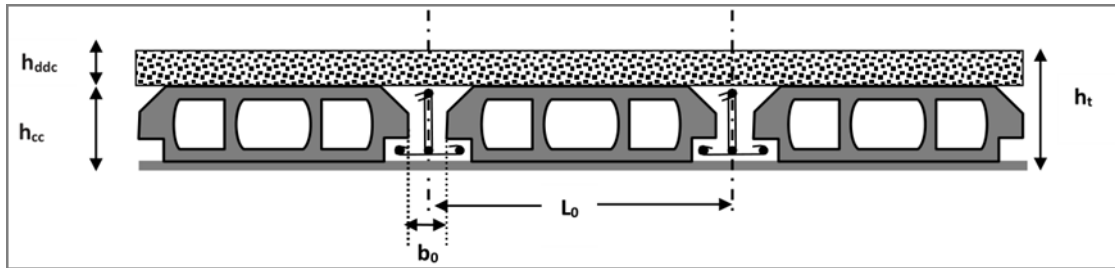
Coupe transversale sur un plancher à corps creux.
